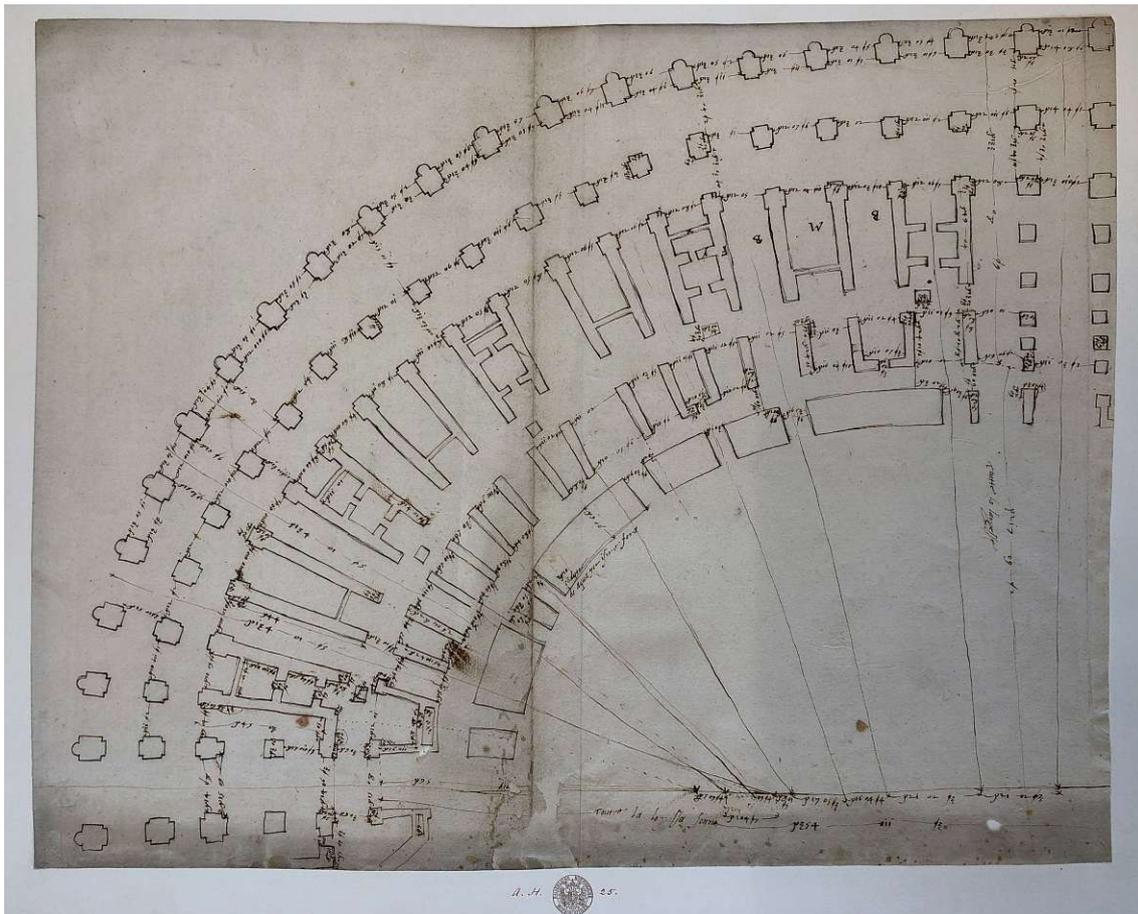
Recto: Kolosseum: Teilgrundriss des nordwestlichen Quadranten | Erdgeschoss
